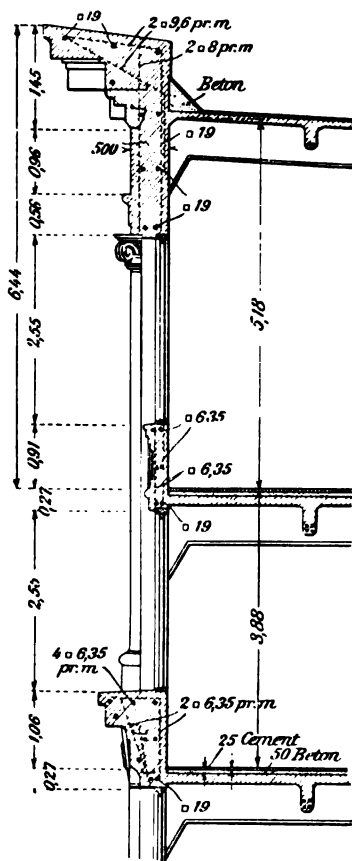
u. 31. Amerikanische Dach- und Gesimskonstruktionen.
